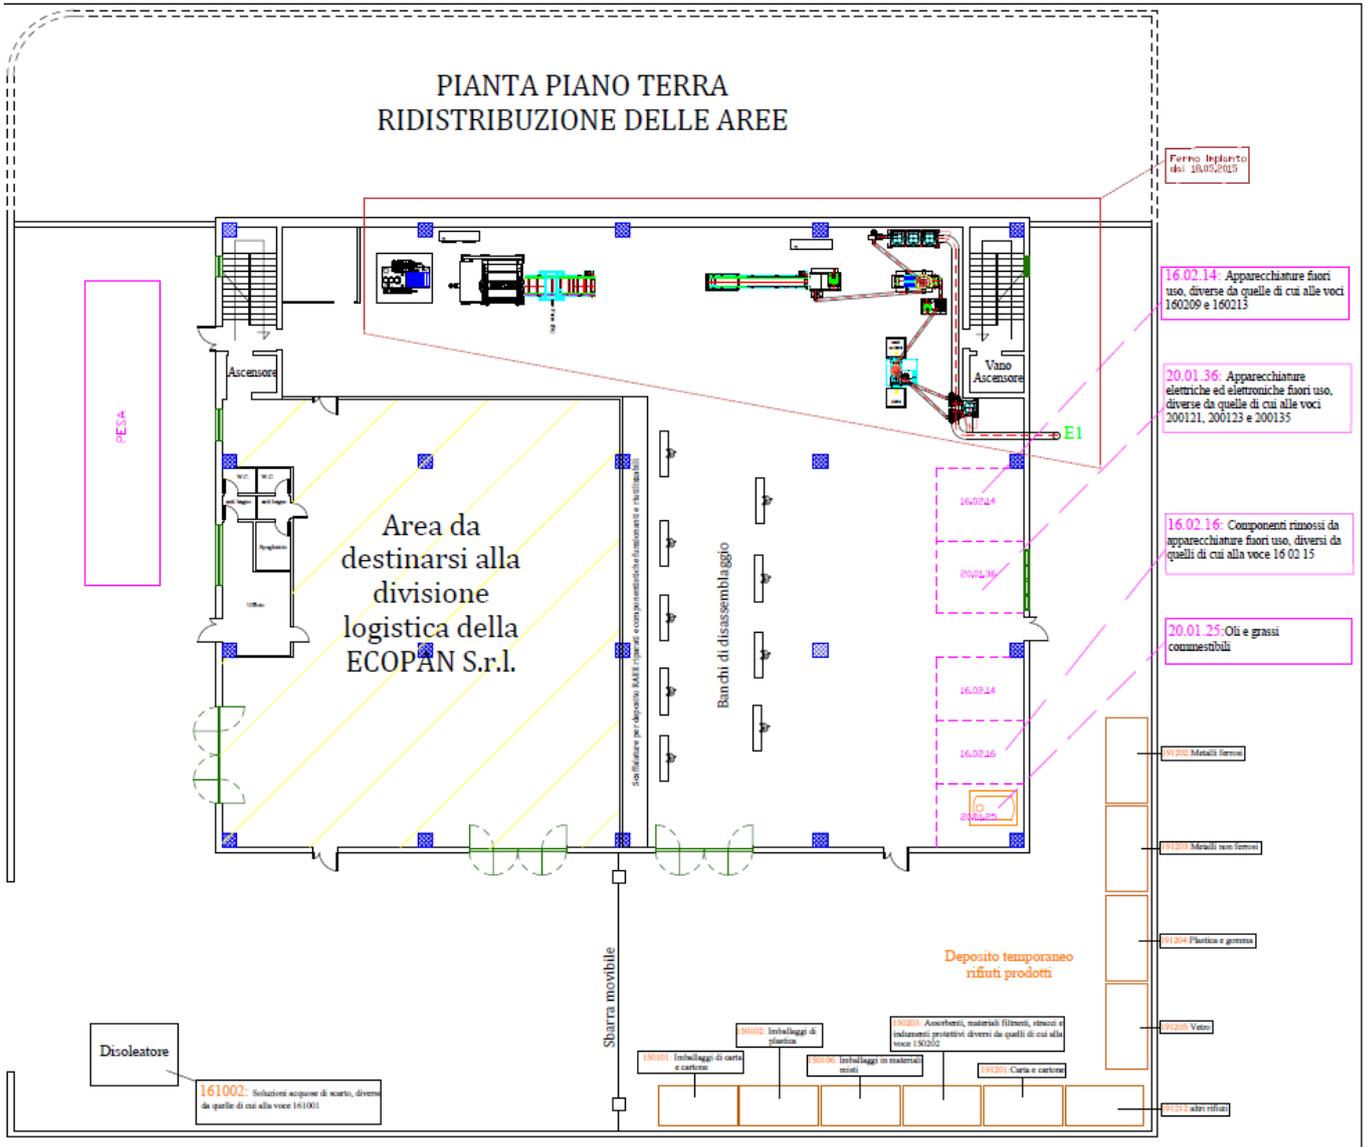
Planimetria piano terra con redistribuzione aree da autorizzare
